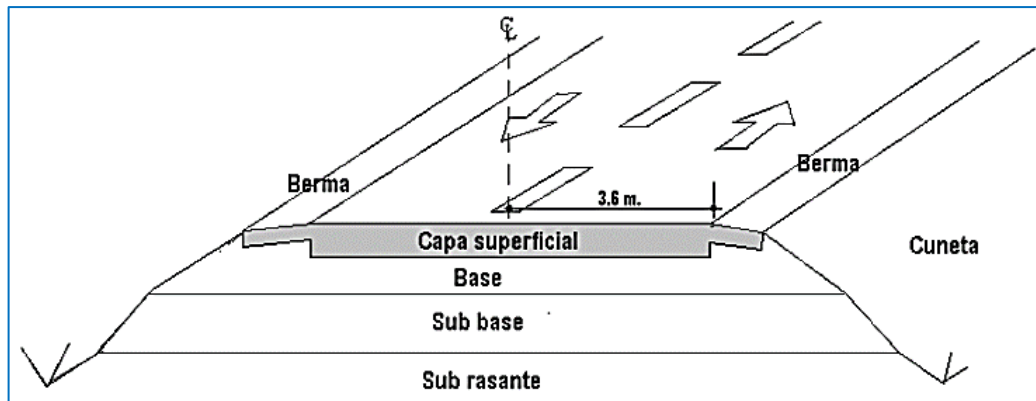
Estructura típica de un pavimento asfáltico (flexible)
